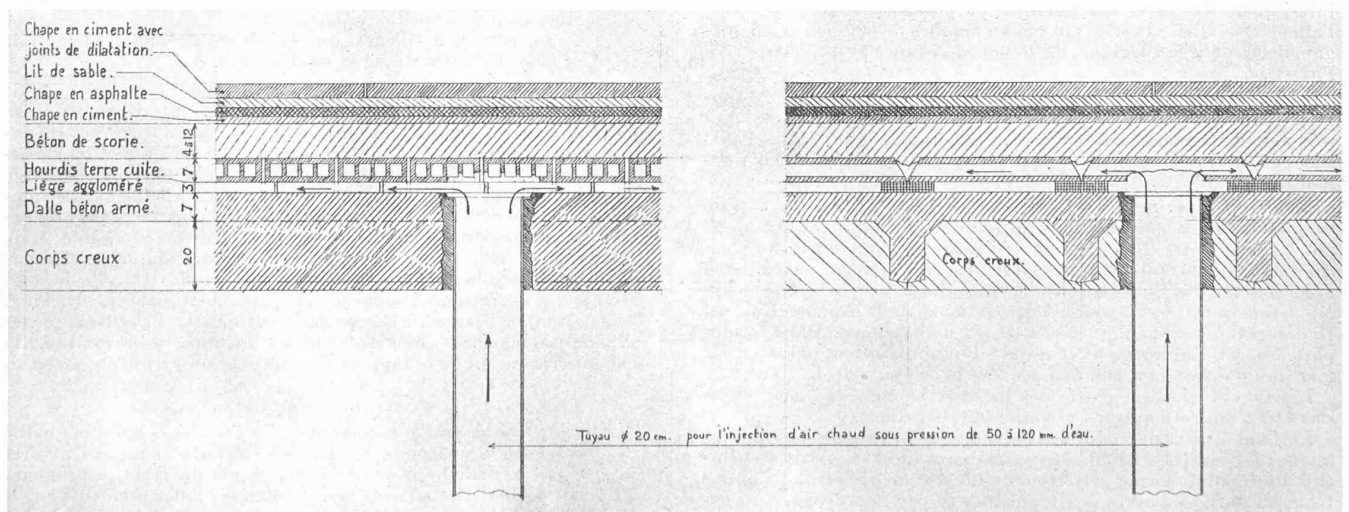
Coupe de la dalle de couverture et ajustement d'un tuyau d'injection d'air.
